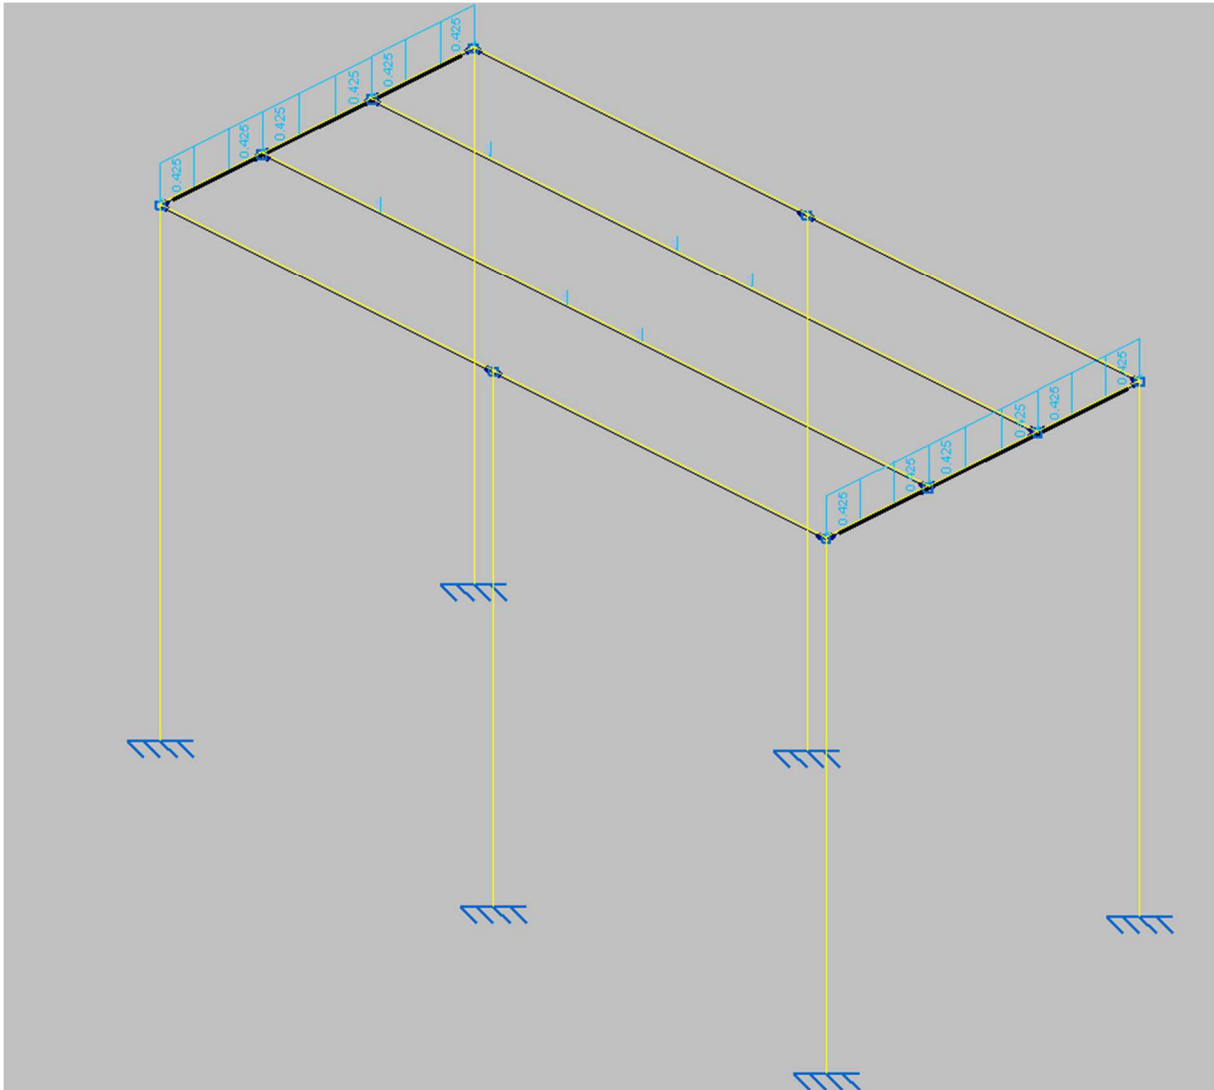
Cargas aplicadas en la estructura del soporte inferior
